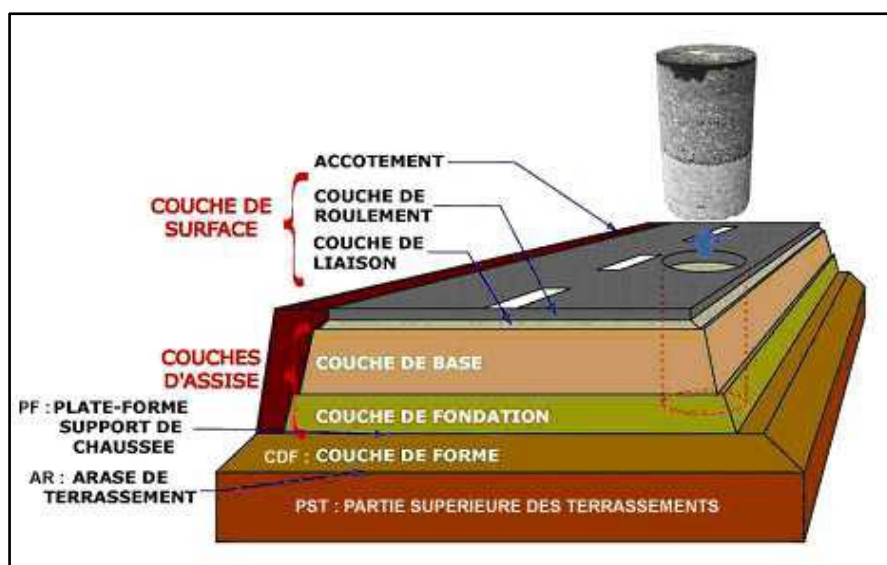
Coupe type d'une structure de chaussée – d'après le cours de Routes de M. VANISCOTE
